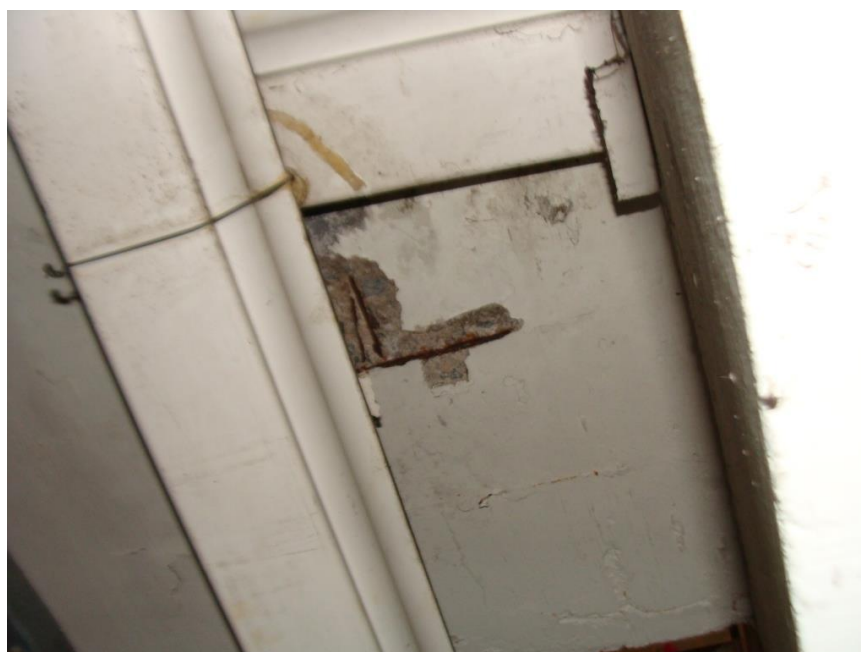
Exposição e corrosão de armaduras na laje L17 (25/02/2021)
